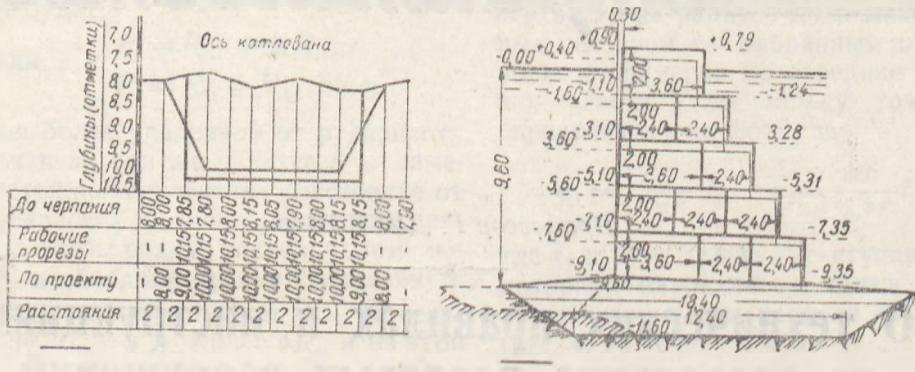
Пример рабочего чертежа — профиля котлована (слева); пример рабочего чертежа — профиля массивовой стенки (справа)
